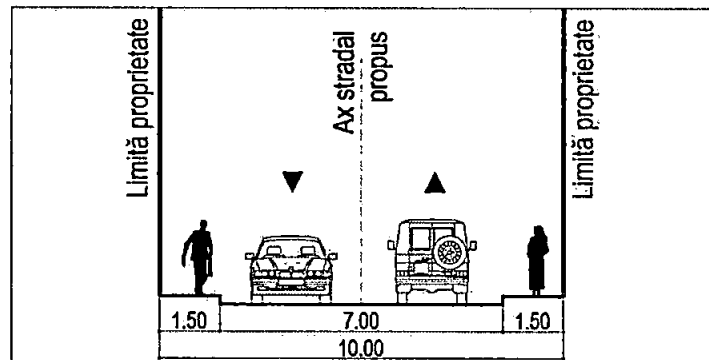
Profil stradal propus - stradă fără nume. Sursa: autori.
